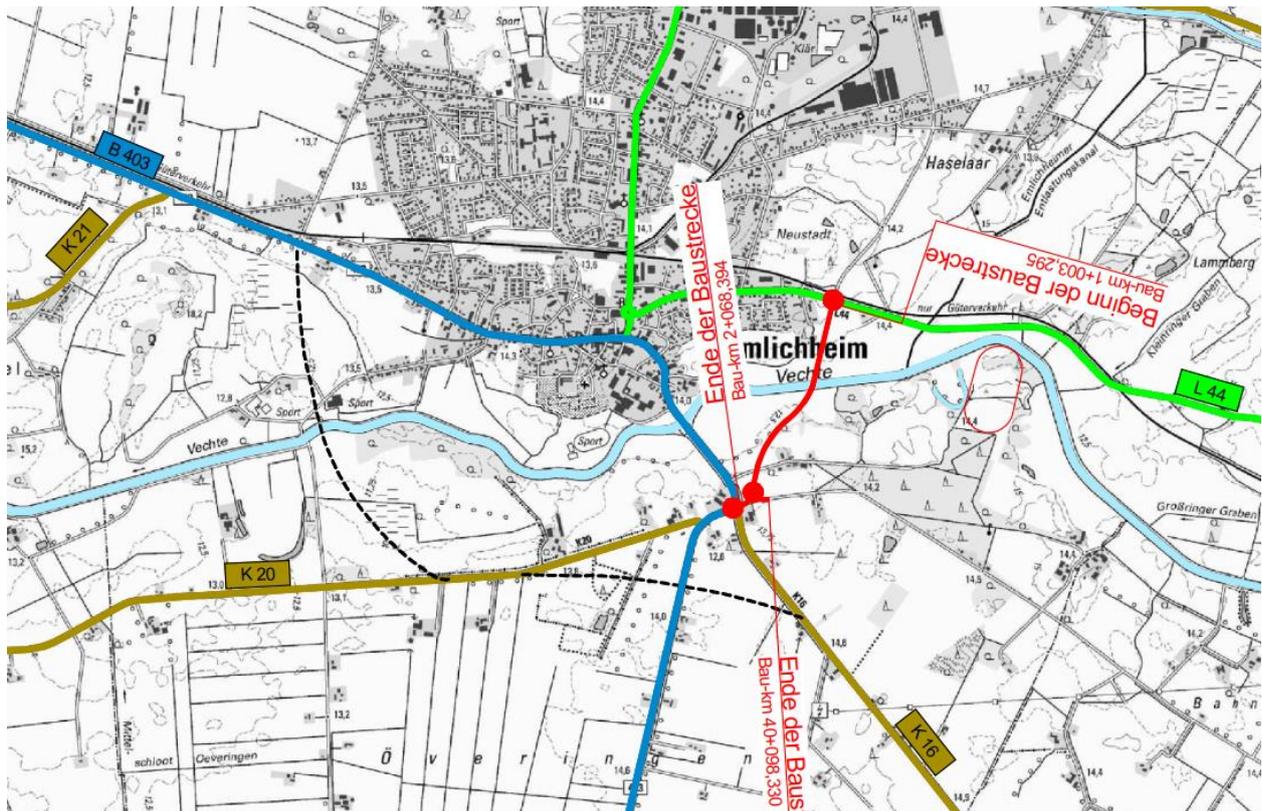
Verlängerung der Straße Obenholt (rot) und Vorzugstrasse für die südwestliche Ortsumgehung Emlichheim (schwarz-gestrichelt) (Gemeinde Emlichheim 2018)
